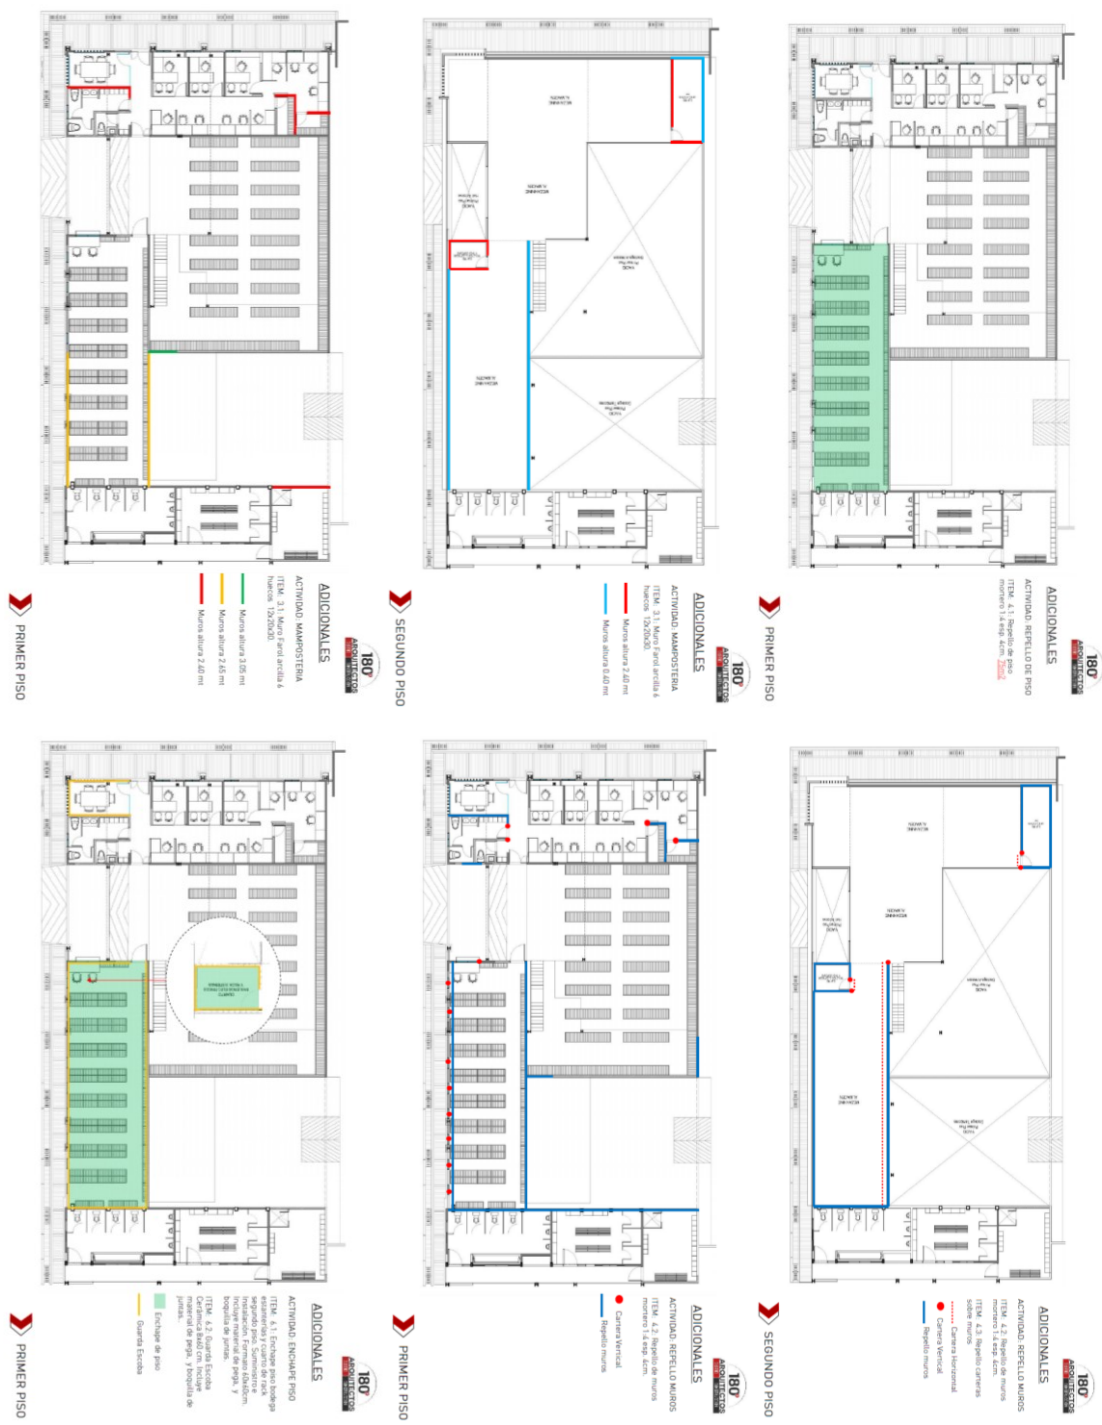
Planimetrías bodegas Graficacion Empresa 180°Arquitectos
